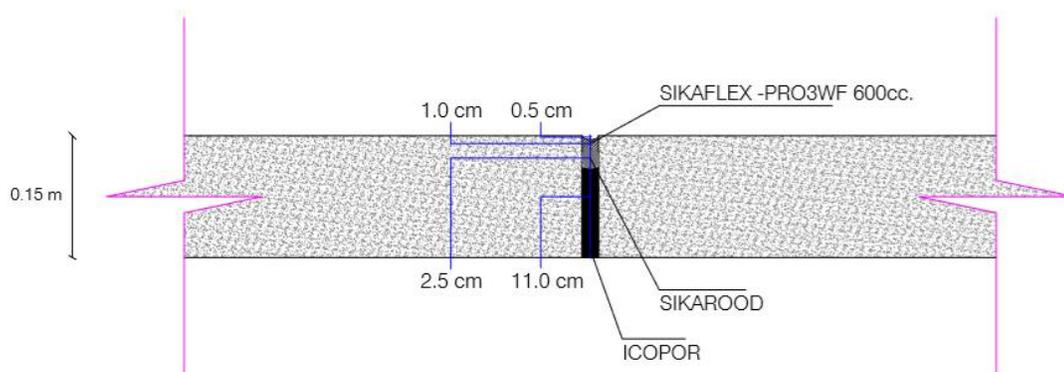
Detalle de junta de expansión en pavimento rígido. Fuente: AMO, 2019.
